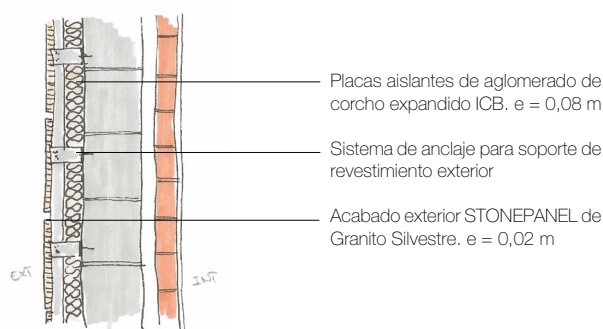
Sistema de fachada ventilada en la pared Oeste (acceso al inmueble) acabado piedra de granito (autoría propia).
